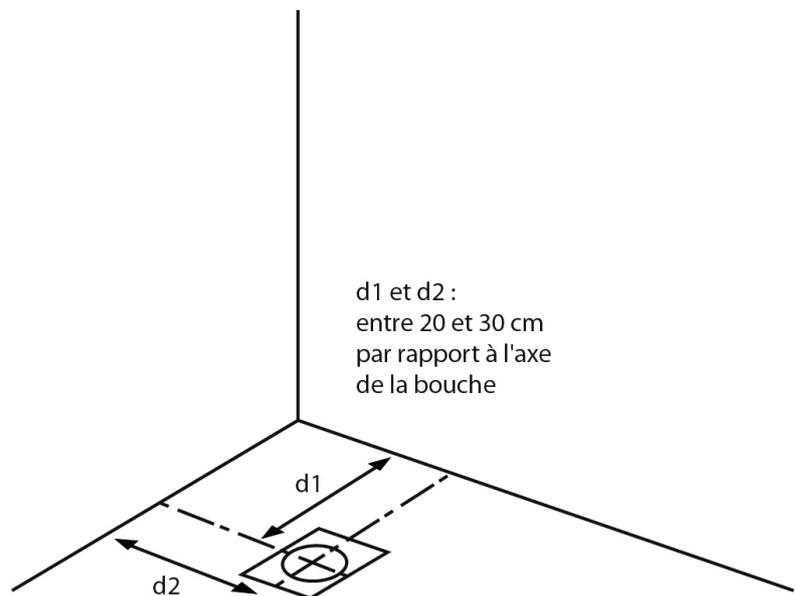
\_2 : Exemple d'installation d'une bouche de soufflage au plafond
